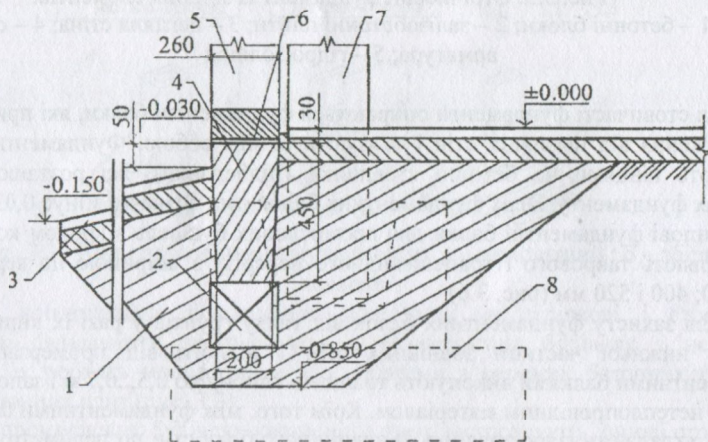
Стовпчастий фундамент із зовнішньою стіною будівлі:
